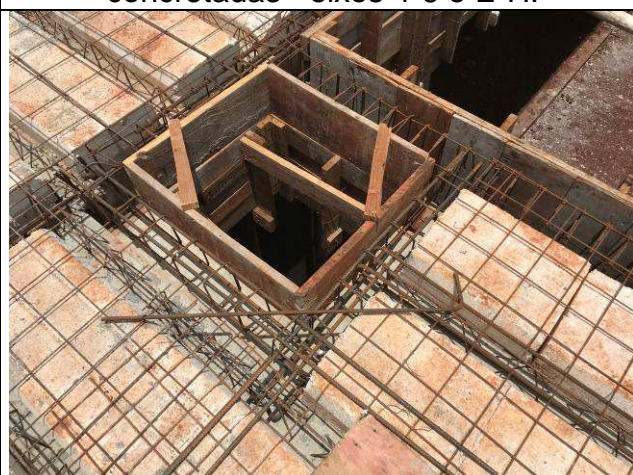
C: Lajes e vigas de cobertura concretadas - eixos 4-6 e E-H.
